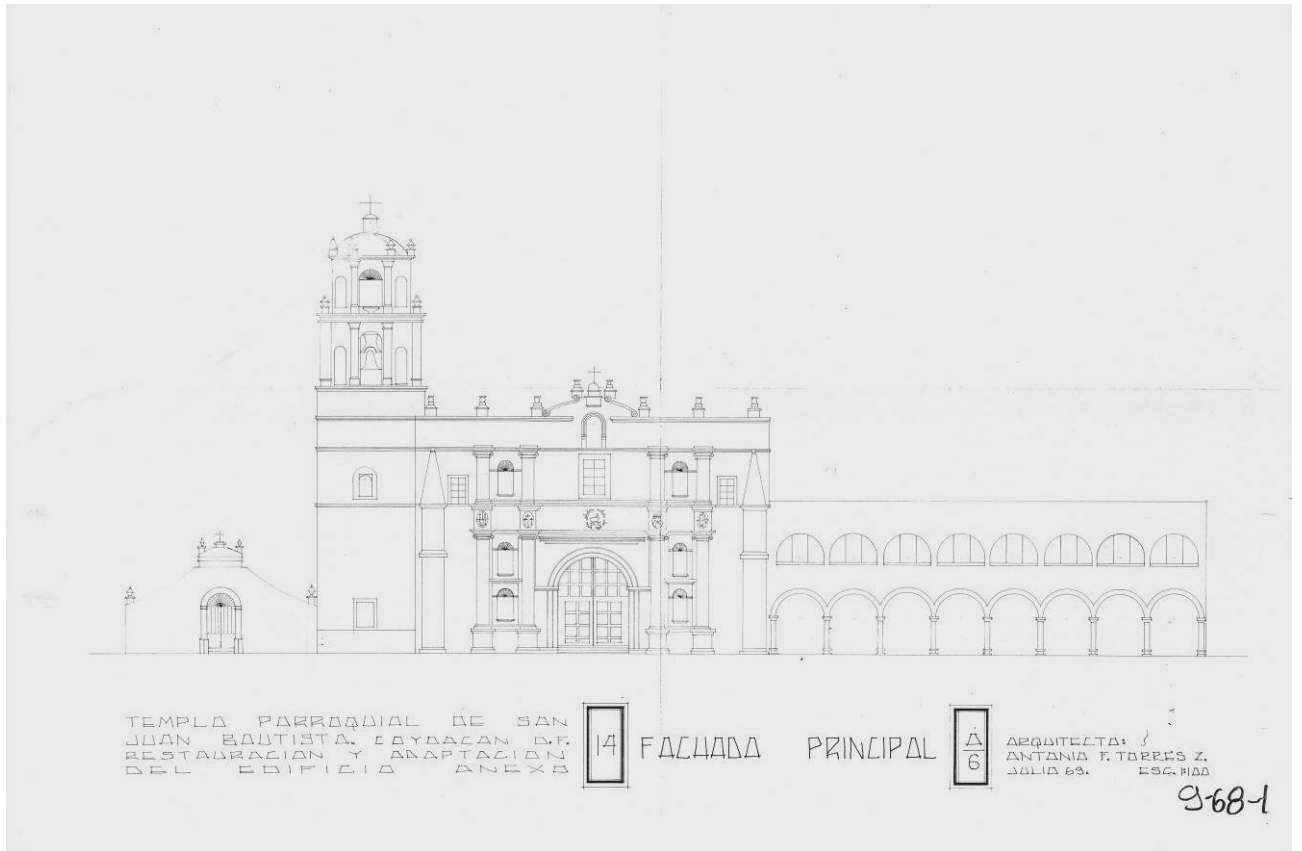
Levantamiento de la fachada principal, con el propósito de apoyar la restauración y adaptación del convento.⁶⁹⁵
